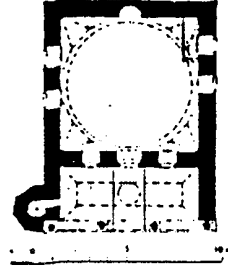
مسقط أفقى للمسجد الملحق
